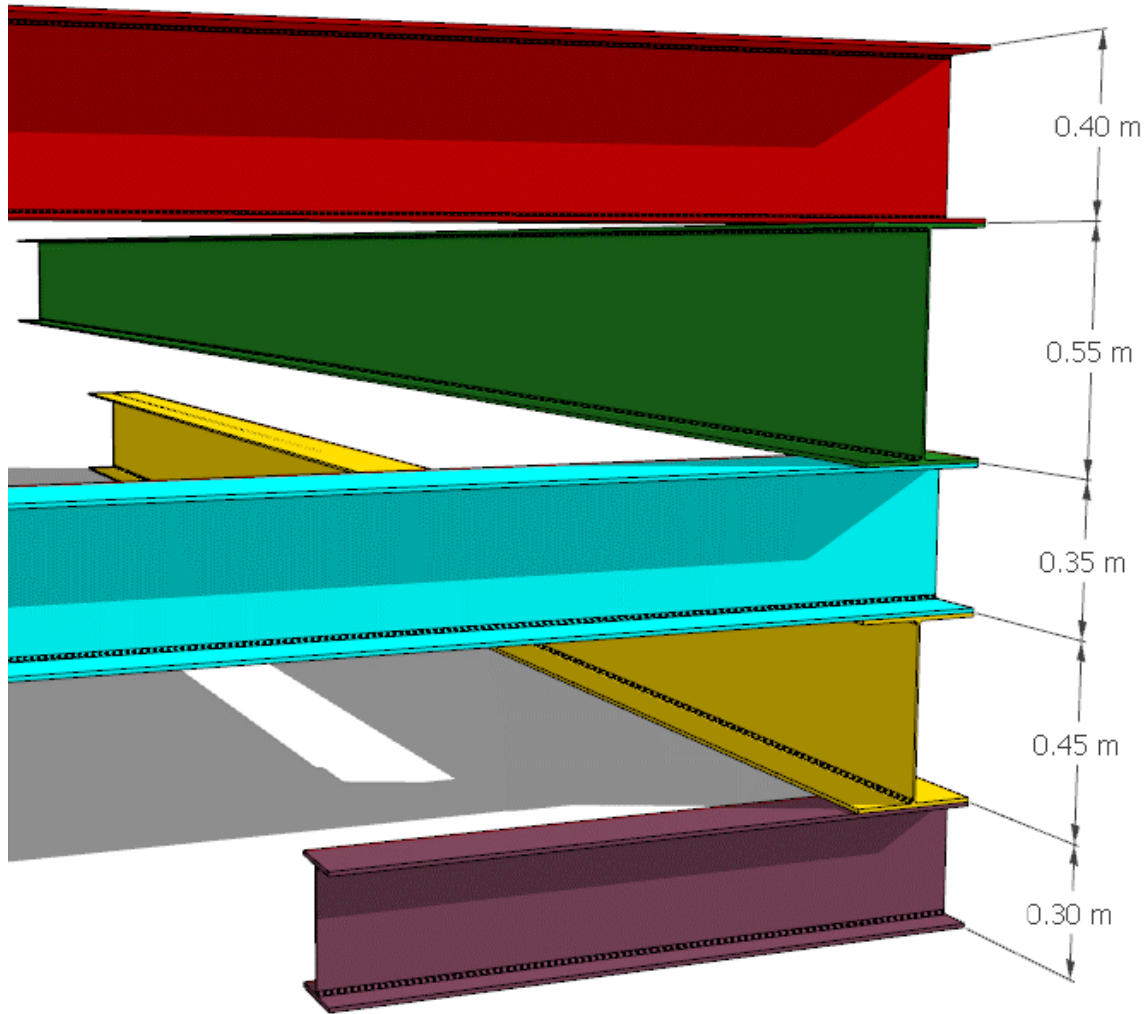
Planta estructural esquemática en perspectiva de la nueva propuesta. Fuente: Elaboración propia
